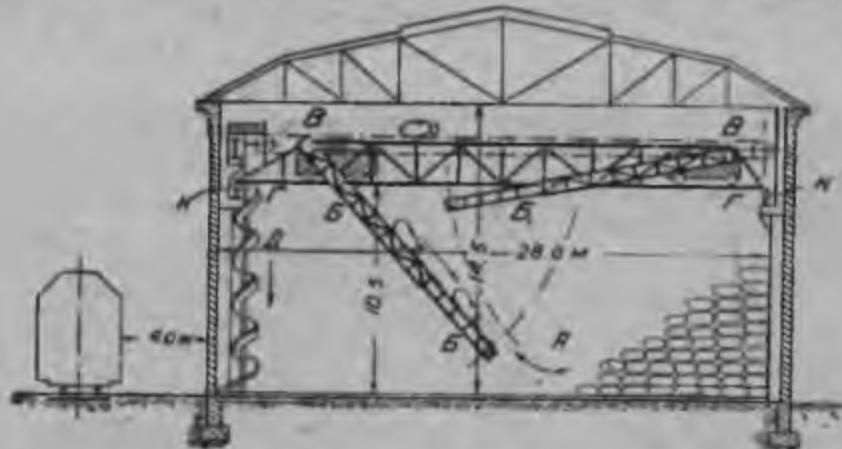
Оборудование склада мостовым краном и лентами для штучных грузов.
